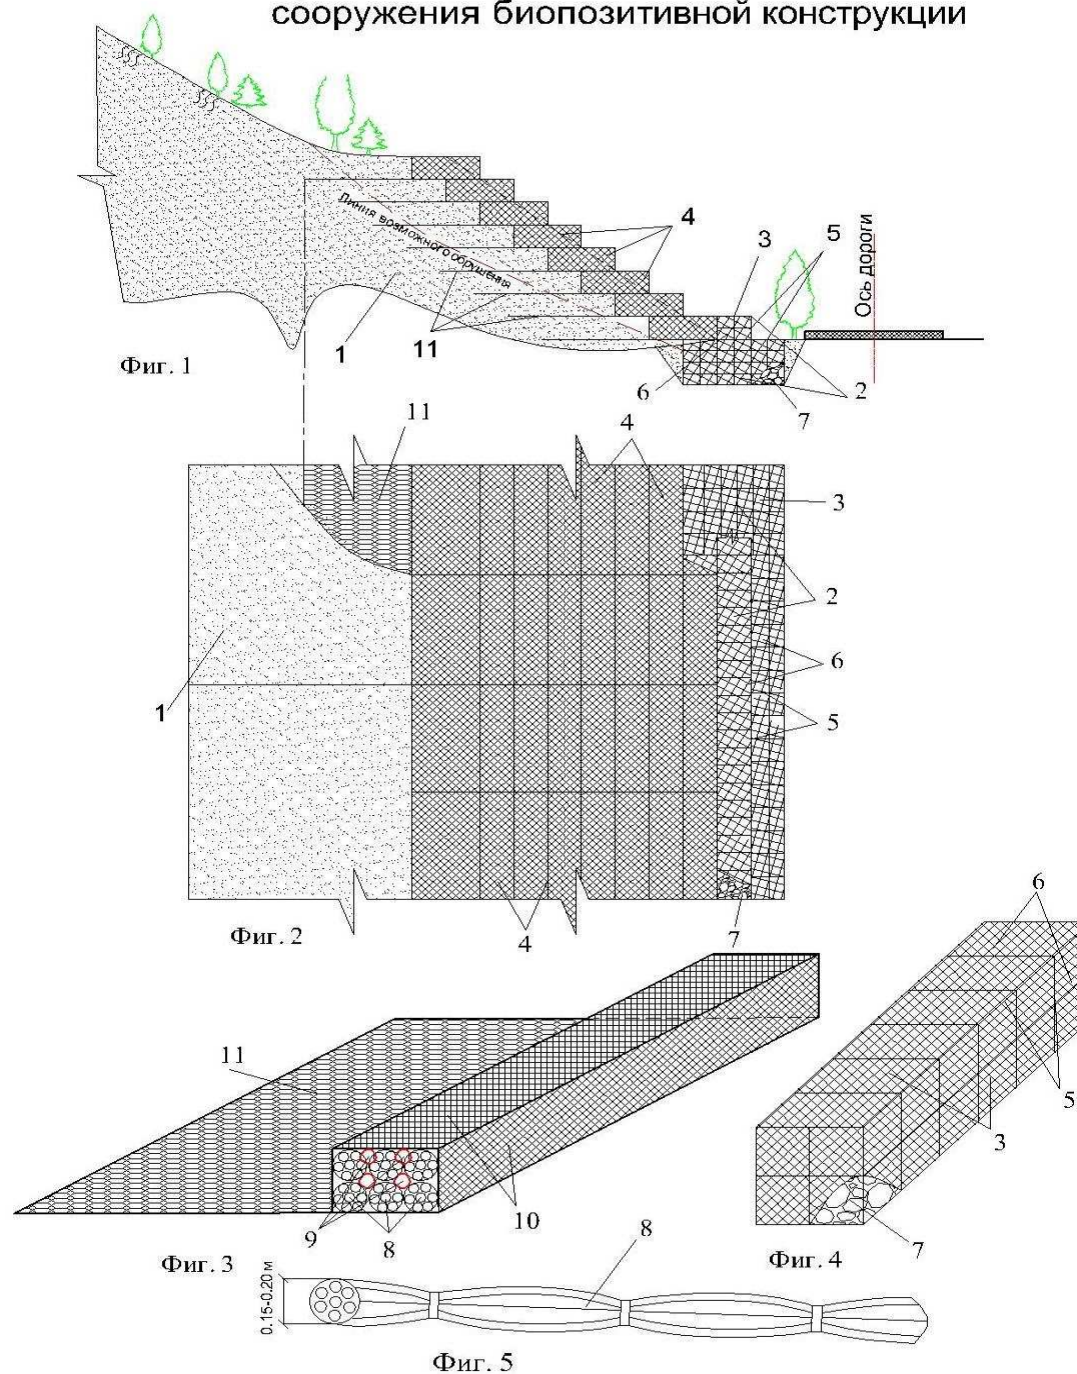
Противооползневое сооружение биопозитивной конструкции состоит из грунтового массива 1, дренажной призмы 2, выполненной из армированных габионов 3, и откосного крепления из габионных тюфяков 4. Габионы 3 выполнены из арматурного каркаса 5, металлической (оцинкованной) сетки 6 и каменного заполнителя 7. Габионные тюфяки 4 выполнены из легких фашин 8, перфорированных полимерных труб 9, габионной сетки 10 и армирующих грунтовой массив гибких сеток 11 из стеклопластиковых материалов.
